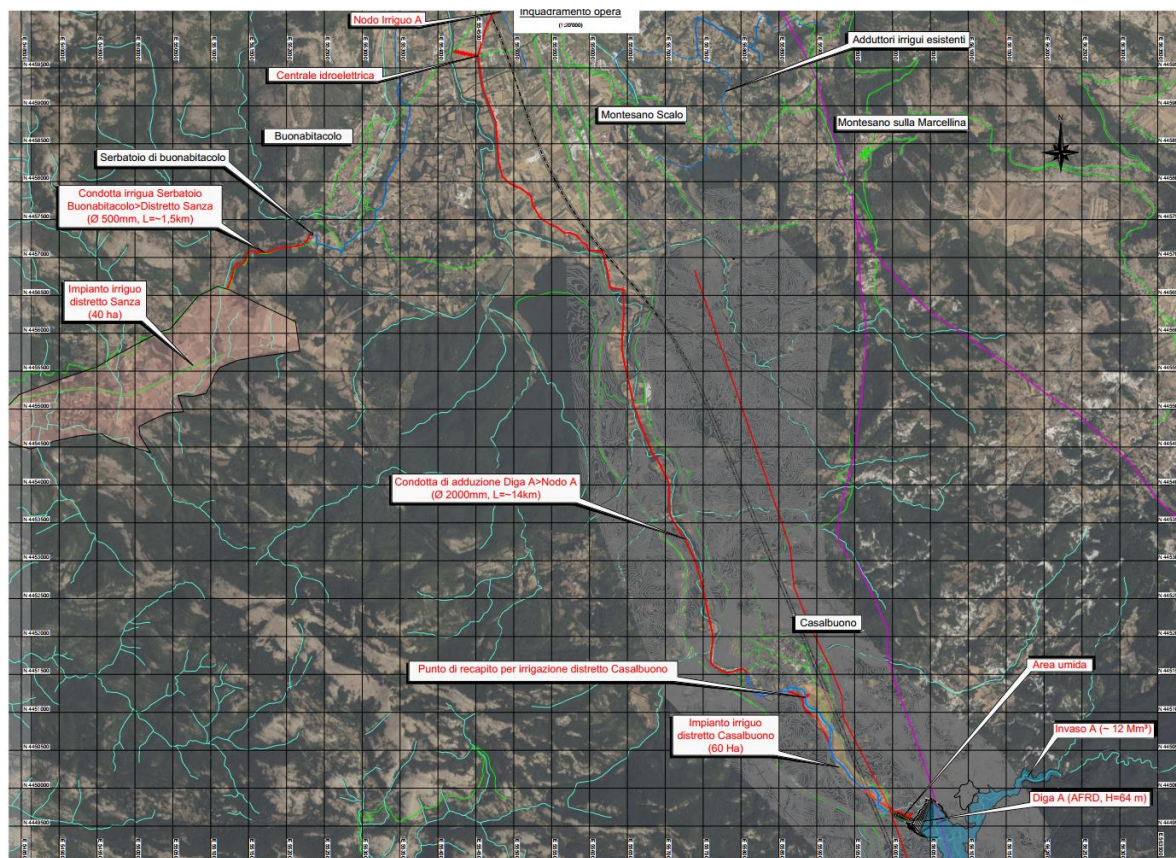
Alternativa 1 (A), schema progettuale planimetria (estratto da [13])
